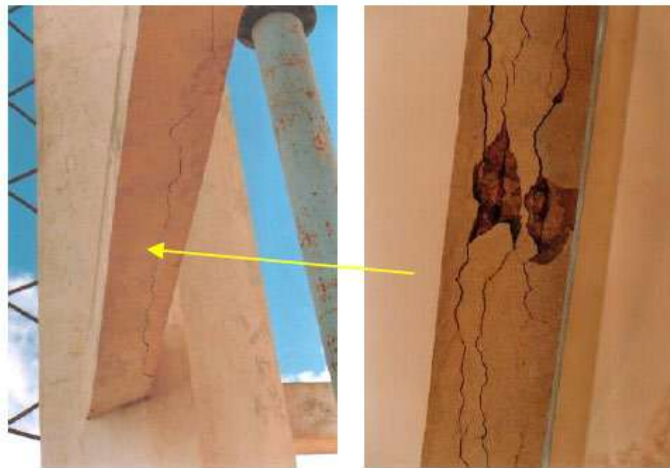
Fissuras na viga de reservatório de concreto armado. Fonte: Borges (2008).
